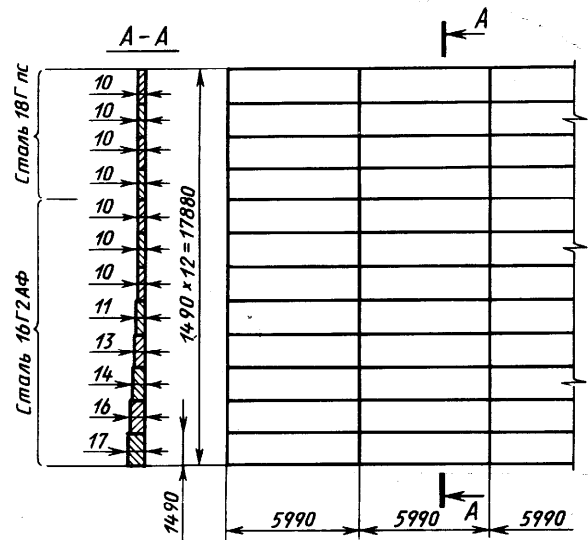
Схема сварного рулонизируемого полотнища стенки резервуара объемом 50000 м³
